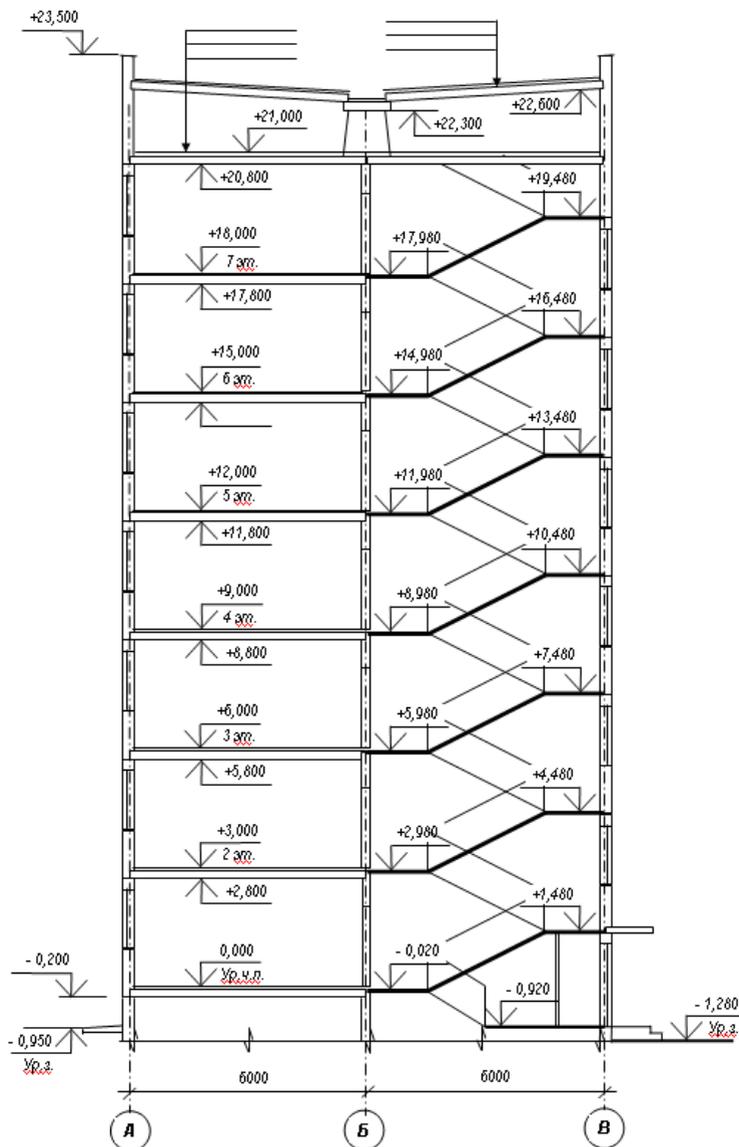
Пример оформления разреза жилого дома со стенами из крупных панелей
